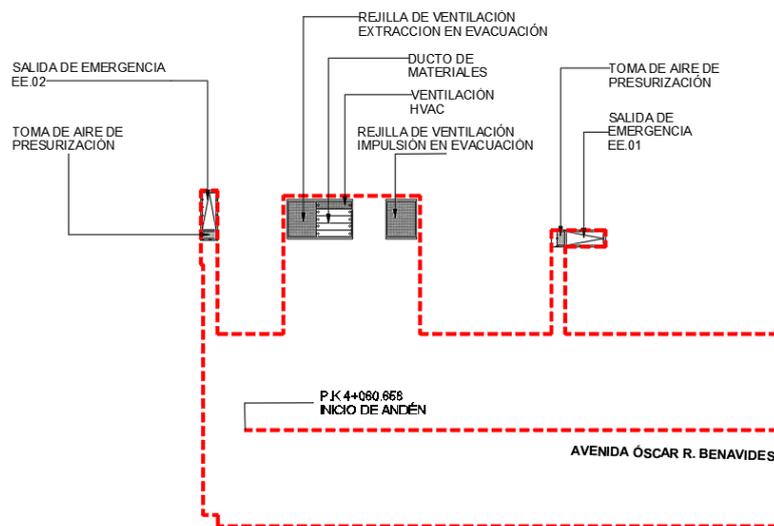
Planta de salidas de emergencia, rejillas y ducto de la estación Insurgentes
